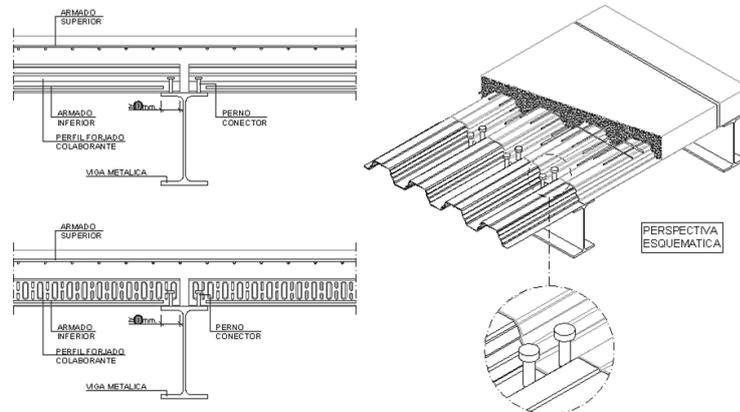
Sección Constructiva de Losacero sobre Viga de Alma Llena Principal
